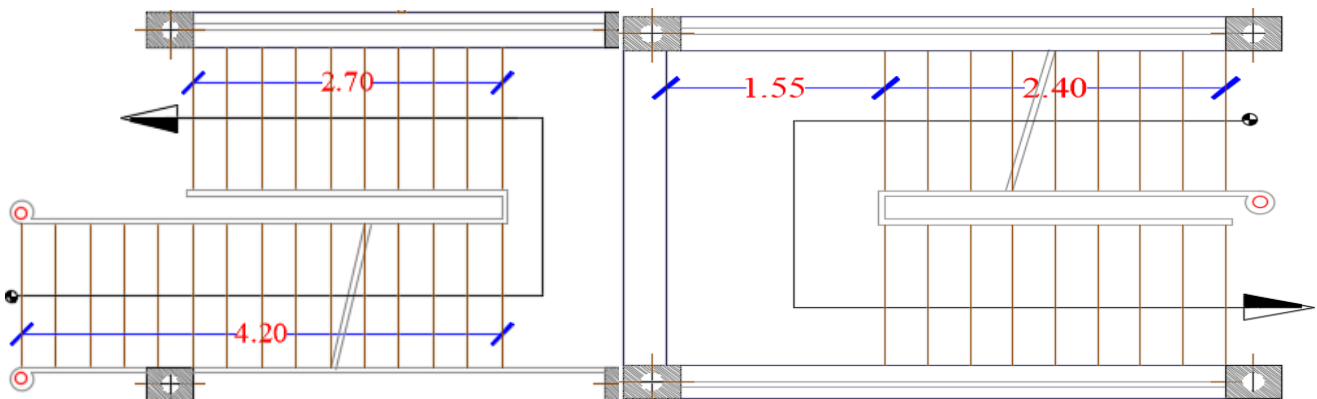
vue en plan de l'escalier SS et RDC
